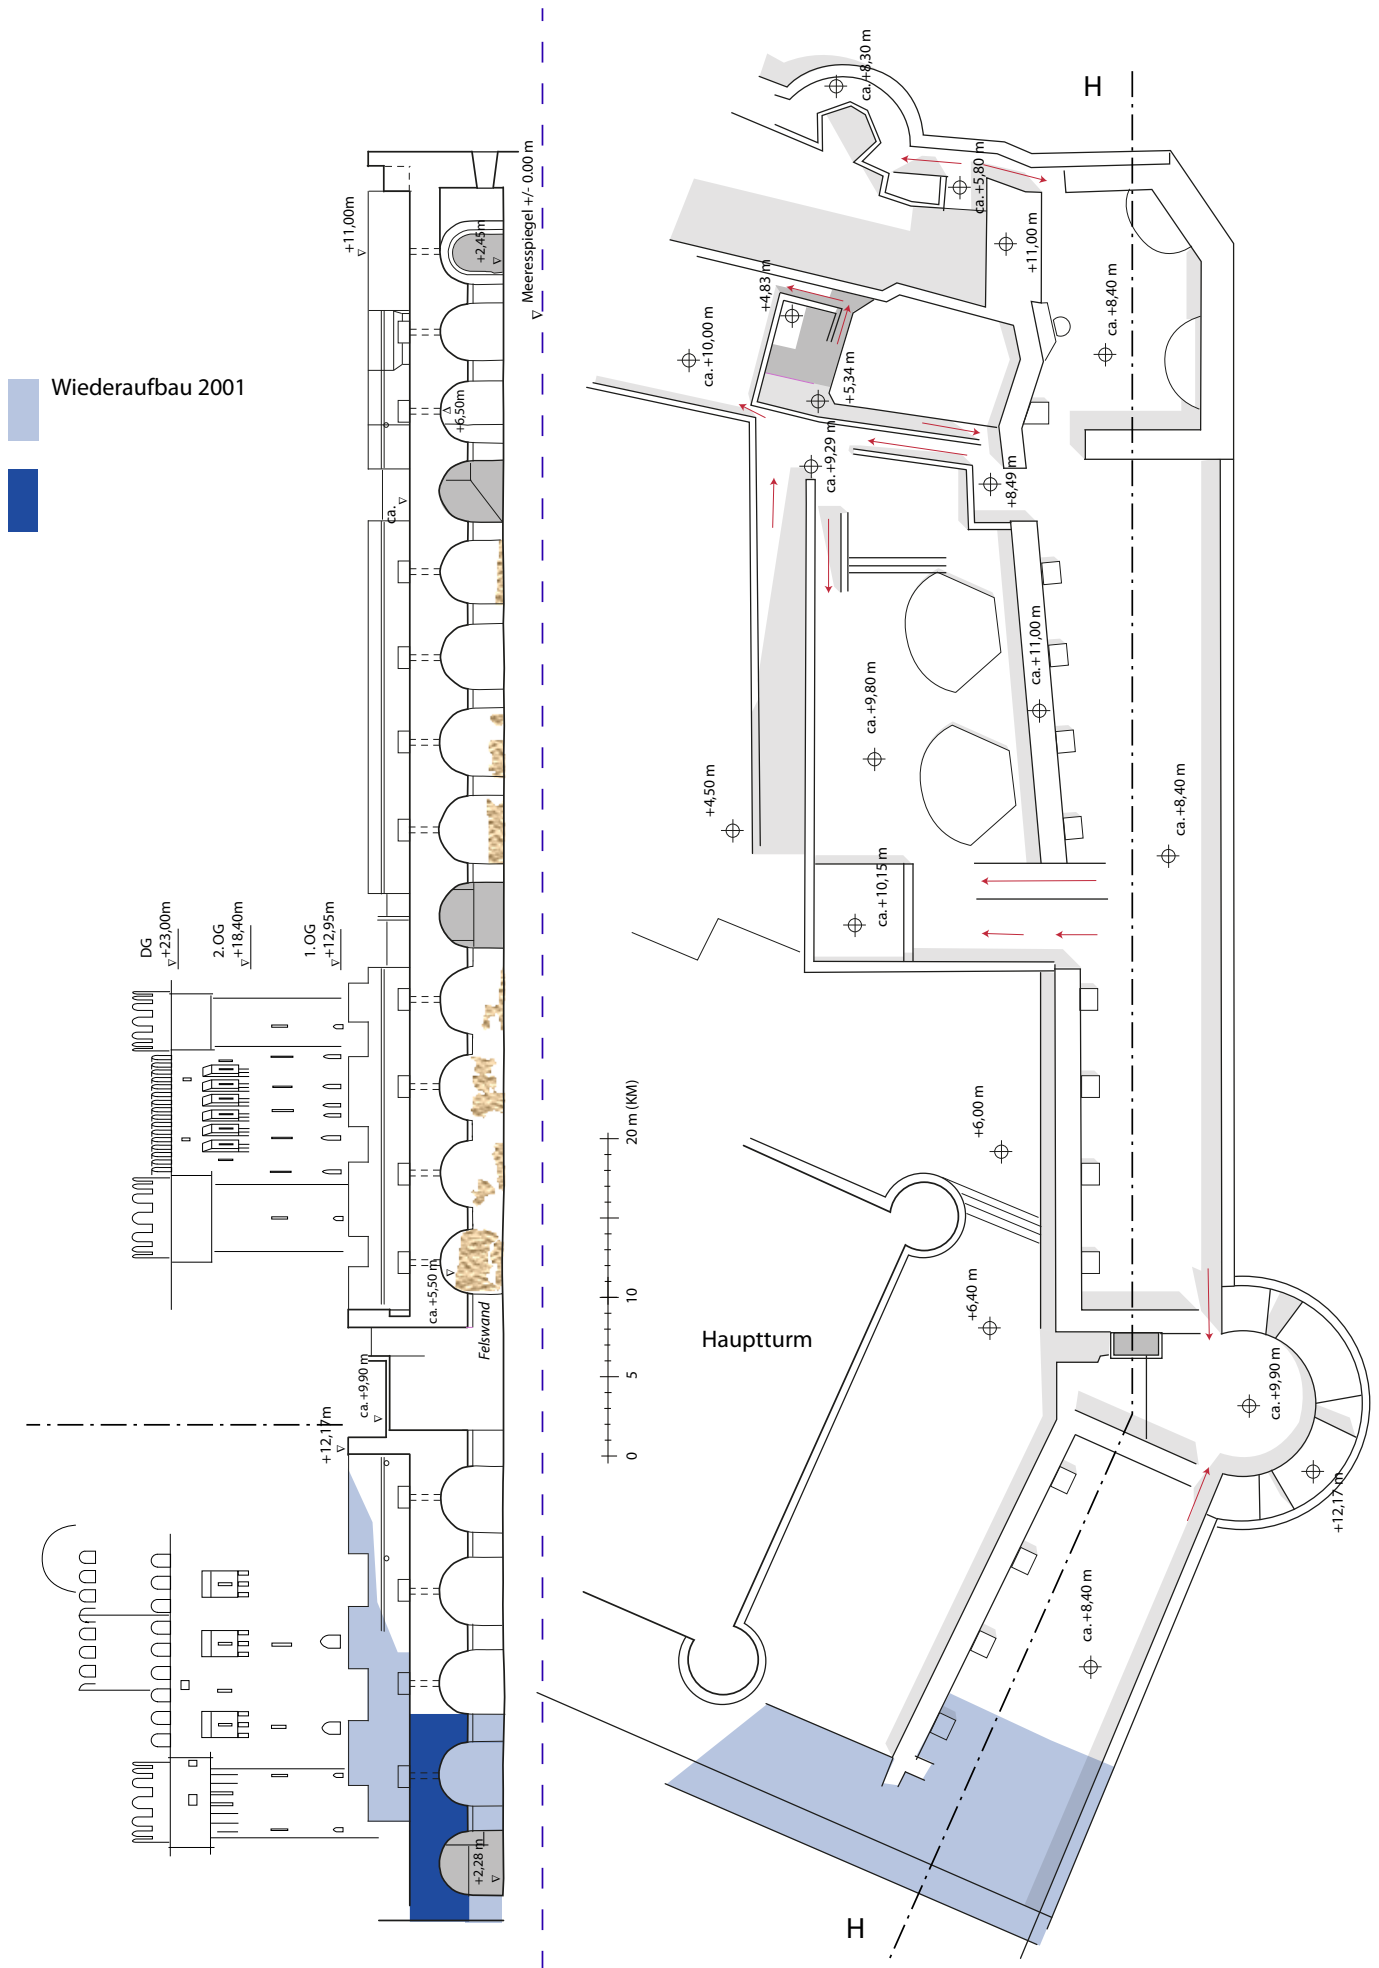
Die nördliche Wehrmauer: Dachaufsicht und Längsschnitt H-H.
